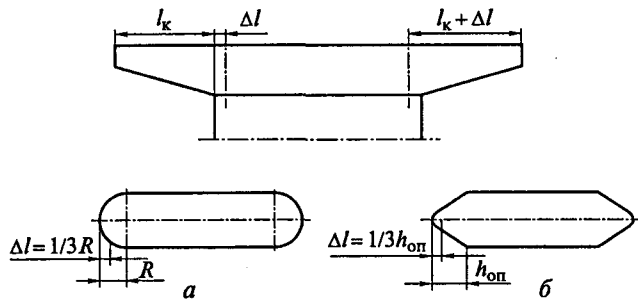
Схемы к расчету консолей ригелей опор:
